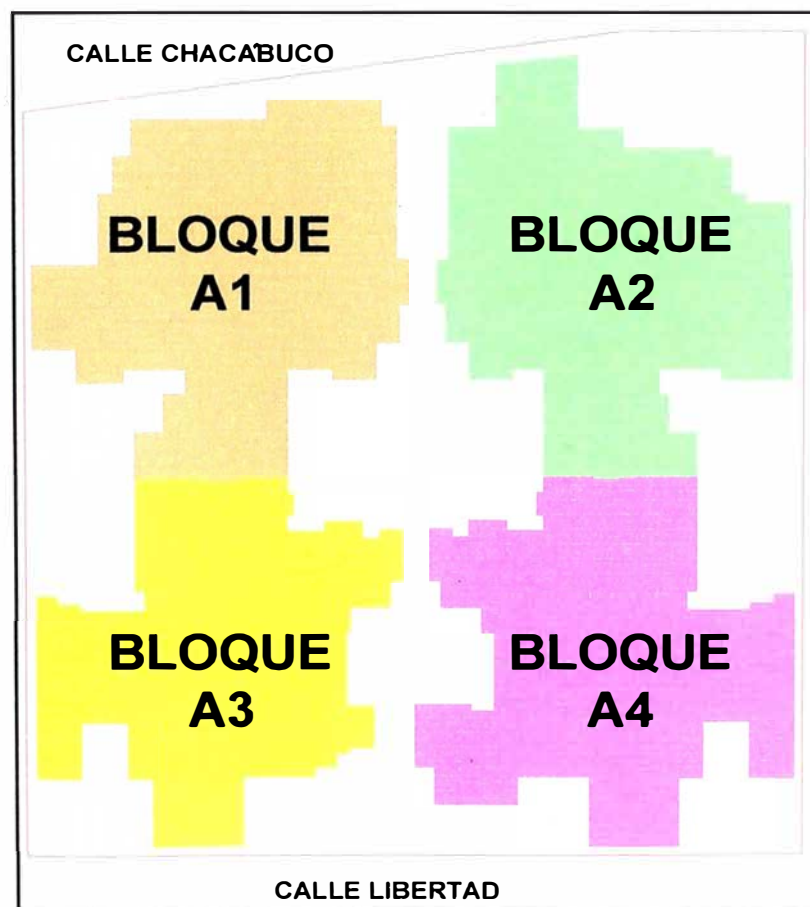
Vista General de la División Arquitectónica del Proyecto (4 Bloques)
